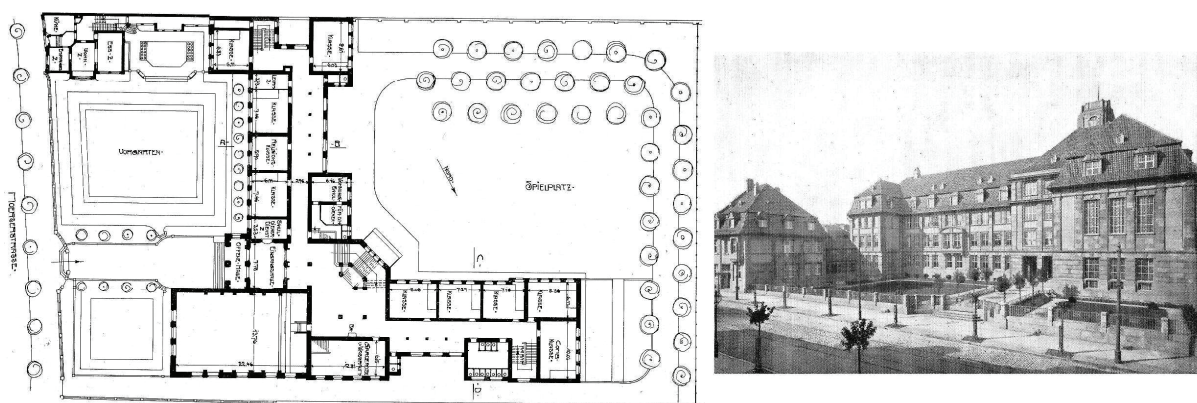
Höhere Mädchenschule zu Crefeld nach RUMPEN (1911, Lageplan mit Grundriss und Ansicht von der Moerserstraße): Mädchenschule mit Lehrerinnenseminar und Frauenschule, Bauplatz: 7440m², Schulgebäude: 2012m², Direktorwoh nhaus: 177m², Vorgarten: 613m², Schulhof und -garten: 3235m², Durchfahrt: 403m² In: Das Schulhaus. S.208 und 215. 1912. 14. Jahrgang.
